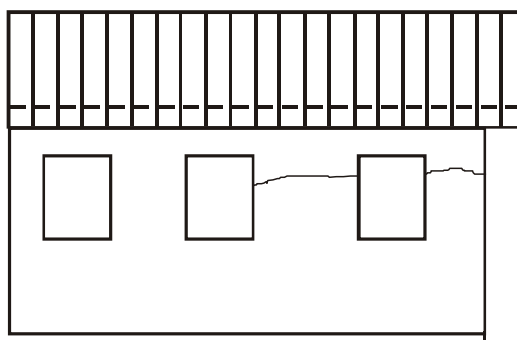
fissura horizontal na parede de fachada por movimentação térmica da laje (DUARTE, 1998)
